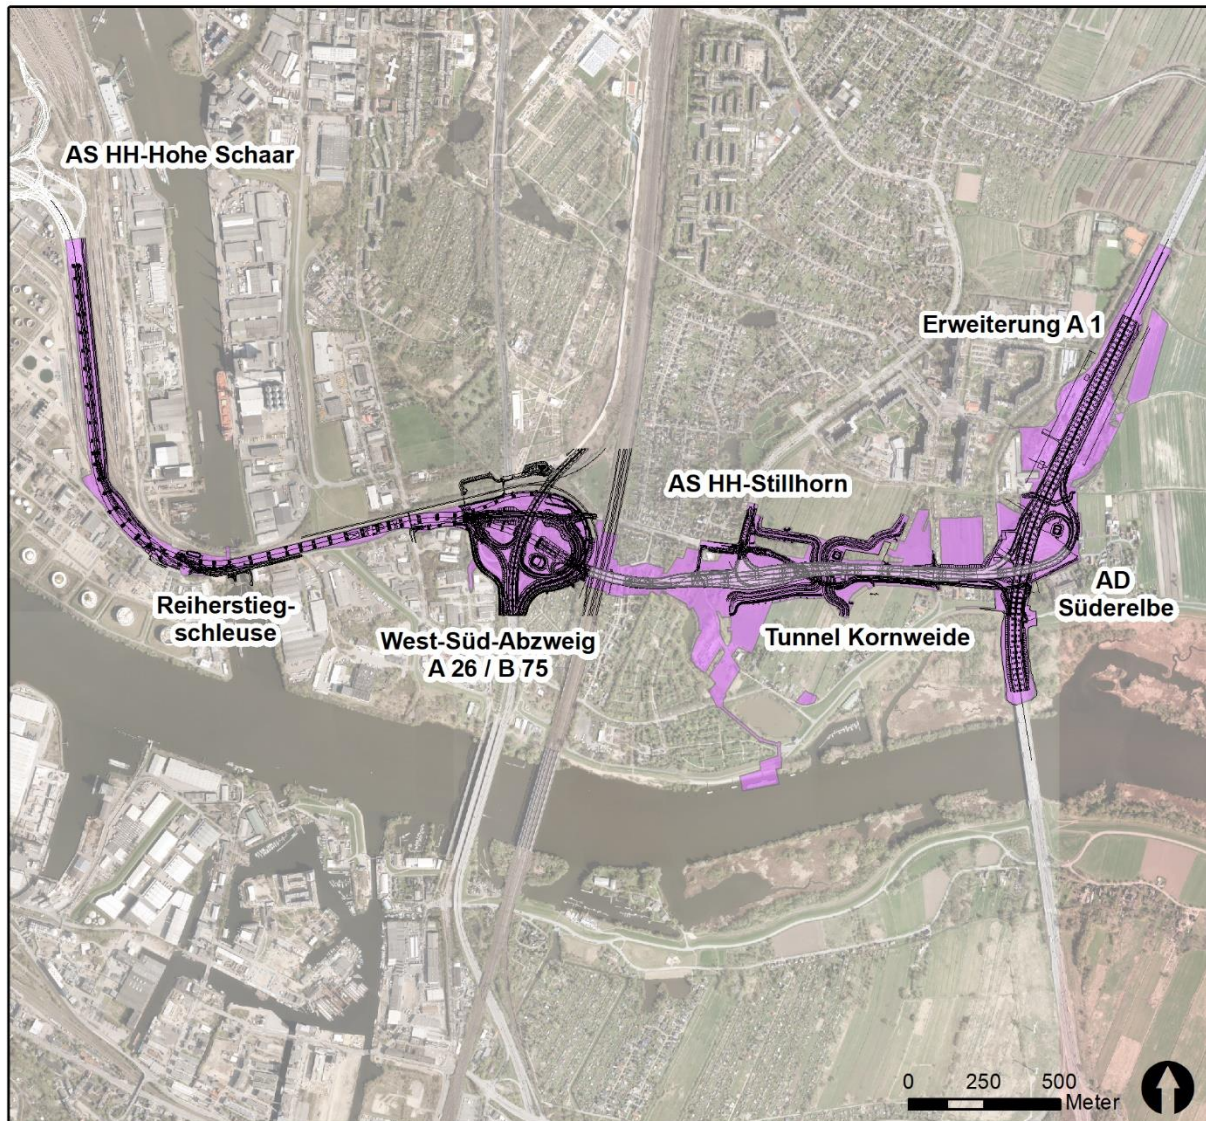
Lage der Trasse der geplanten A 26 Hafenpassage 6c mit dem Ausbau der A 1 und der Baueinrichtungsflächen (lila). Im Westen ist der geplante Abschnitt 6b in weiß dargestellt.
